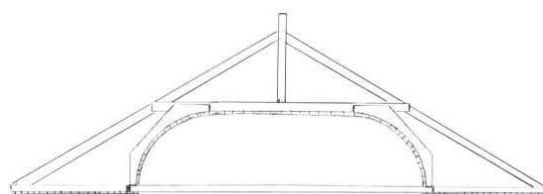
Esboço e corte transversal da estrutura do teto estudado (MARTINS, 2008:85).
